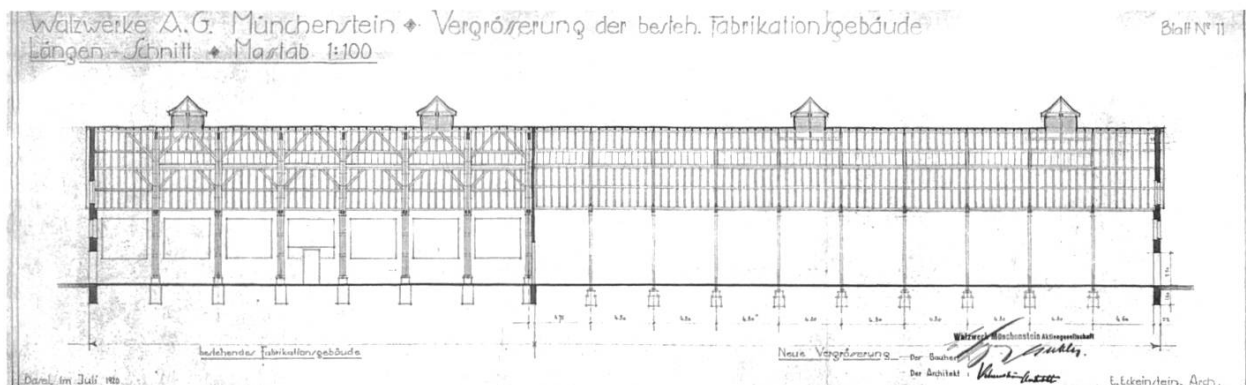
Bauplan von Juli 1920, Längsschnitt der bestehenden und projektierten Fabrikationsgebäude mit Ventilationstürmchen. Gezeichnet von Architekt Ernst Eckenstein, für die Bauherrschaft unterzeichnen im Namen der Walzwerk Münchenstein AG Direktor Wagner und Bauleiter Huber. StABL, Baugesuche Münchenstein, Walzwerk (1920).
